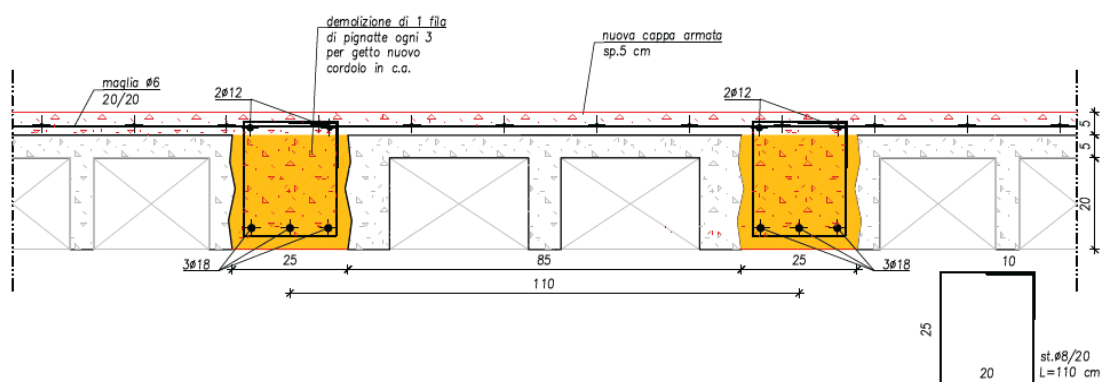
Stalcio dell'intervento di consolidamento del solaio in latero-cemento – Piano primo
